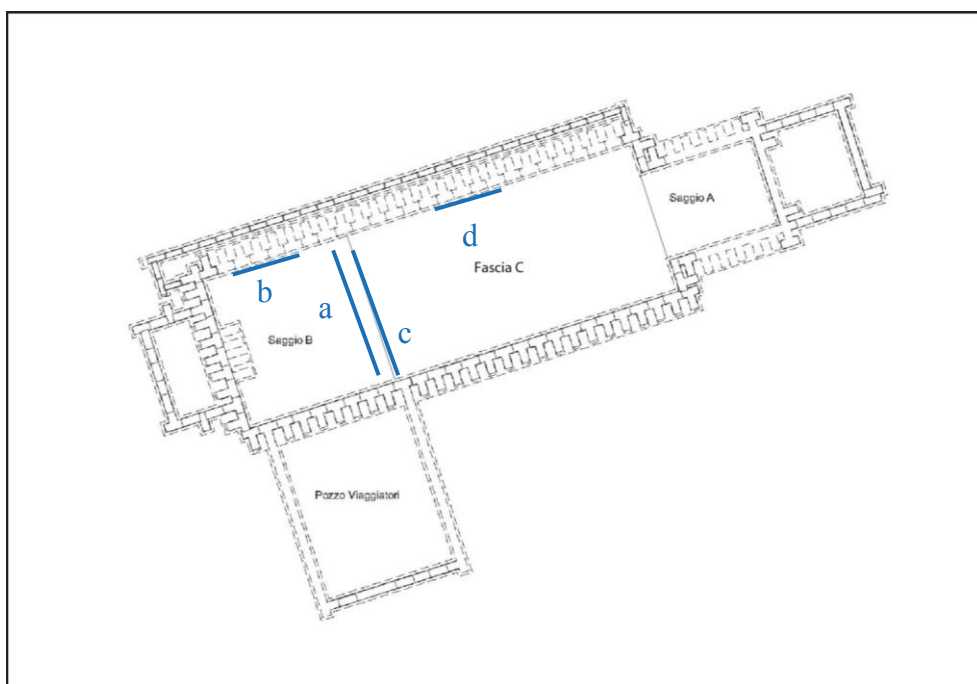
Pianta del Cantiere “Arco Mirelli” e ubicazione delle sezioni paleoambientali di dettaglio ricostruite.
